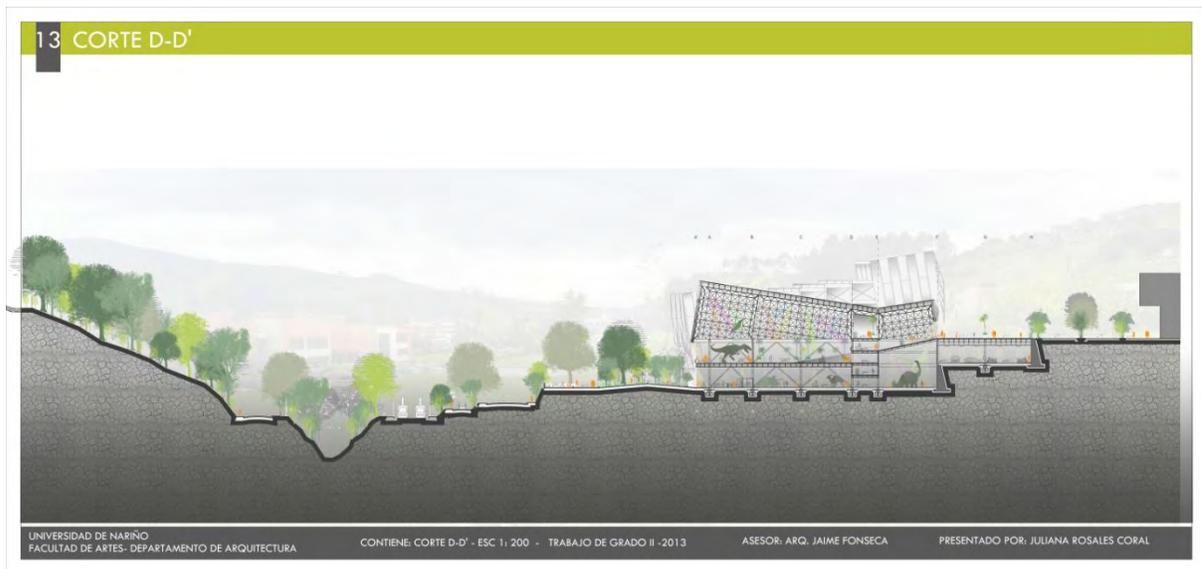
Proyecto_ Corte D-D' // Fuente esta investigación
